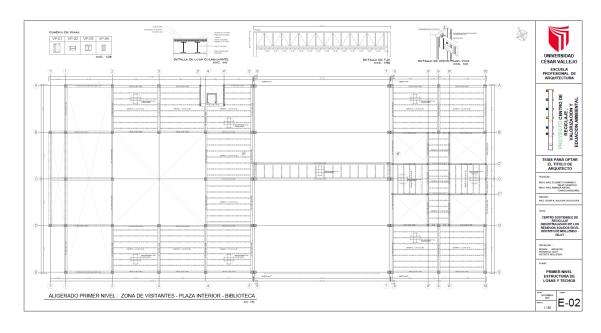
Plano de Aligerados, Sector Seleccionado - Primer Nivel FUENTE: Elaboración Propia
